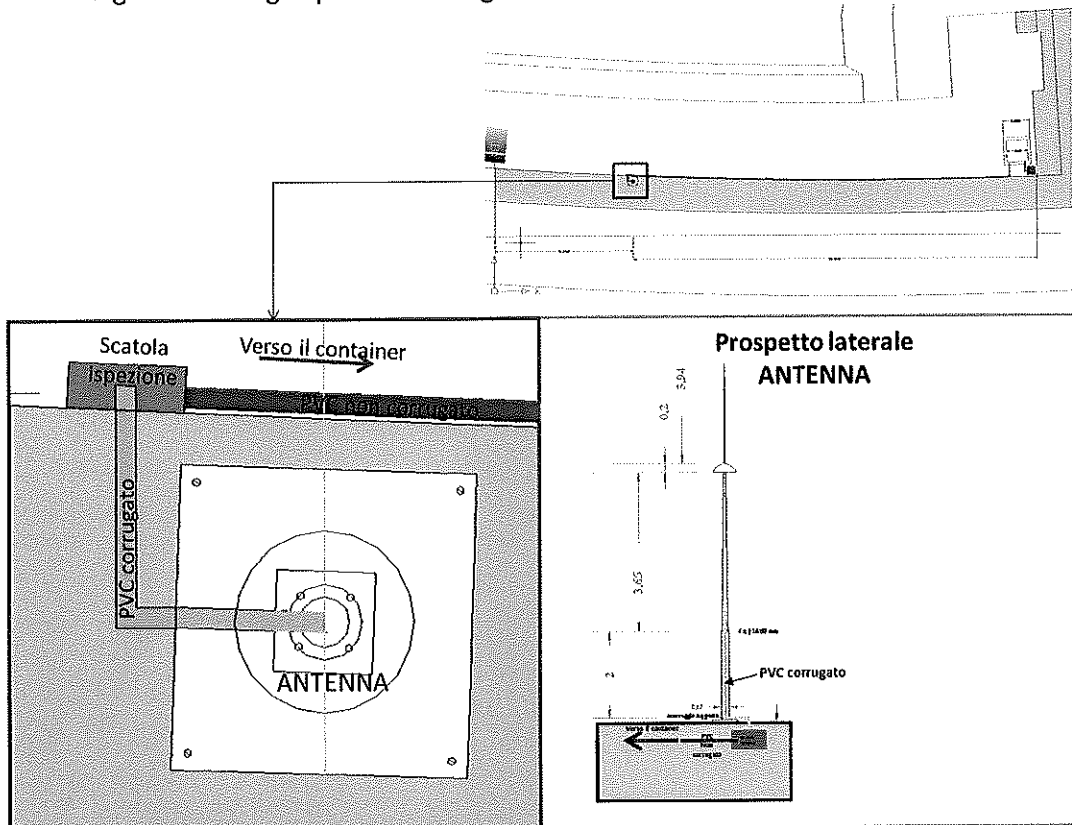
Dettaglio possibile collegamento dati al sito di installazione dell'antenna HF.
